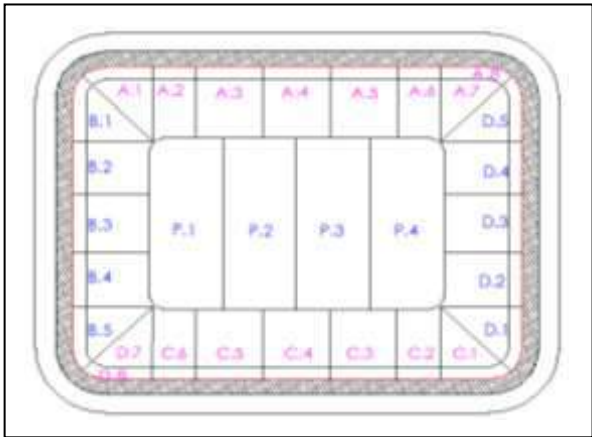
Panjang dan lebar Ukuran Geotekstil Non Woven
